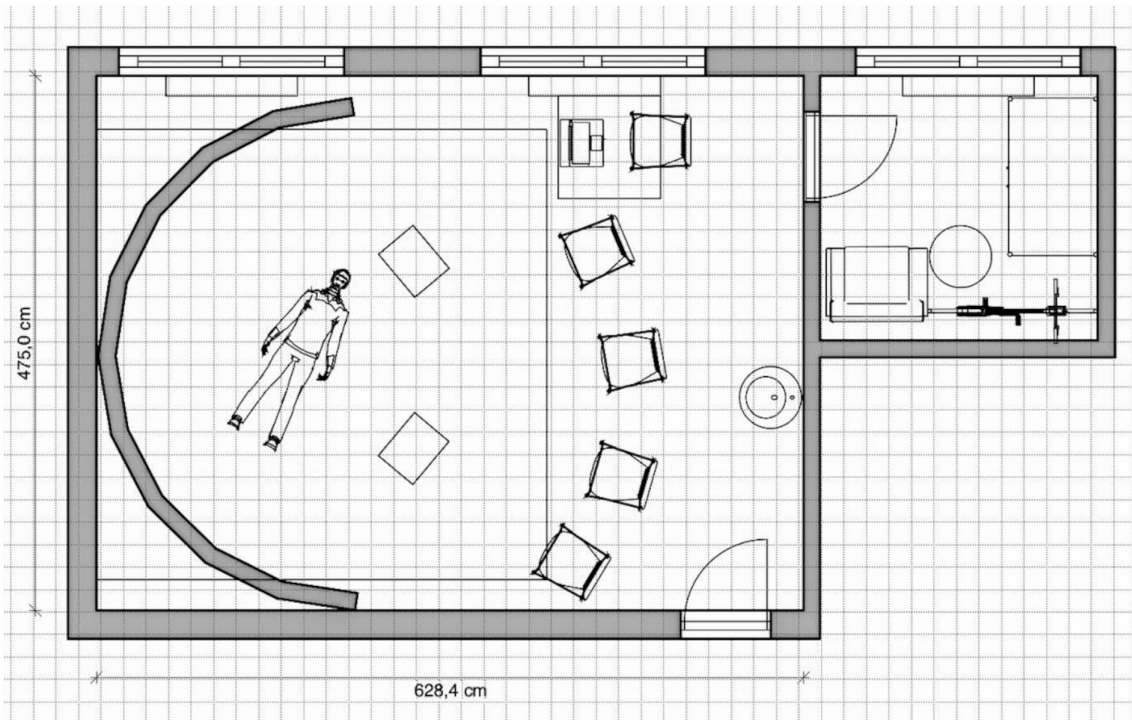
Grundriss der SAM (©Leschowski)
